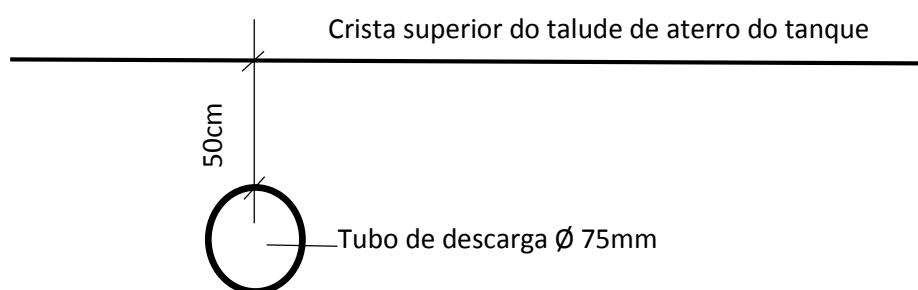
Vista frontal da seção do tubo de descarga (sem escala).
